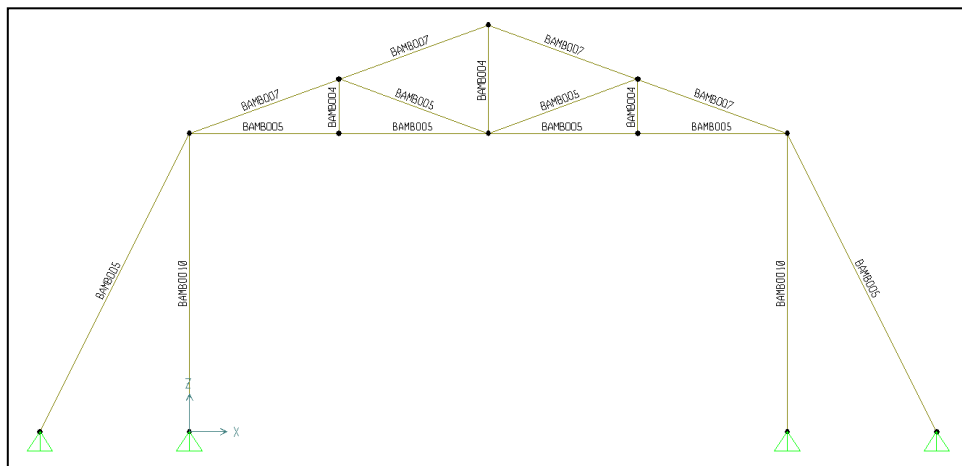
Diámetro de los elementos de la estructura, marco central (plano xz).
